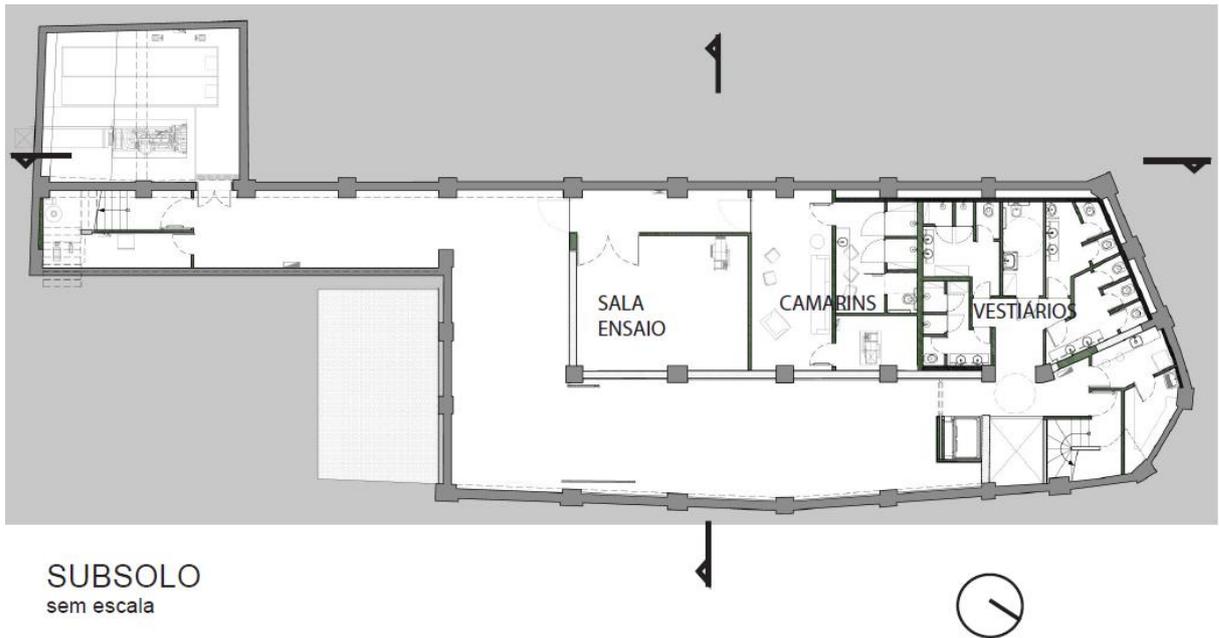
Planta do Subsolo do Centro Cultural *Red Bull Station* (ARCHDAILY, 2013)
